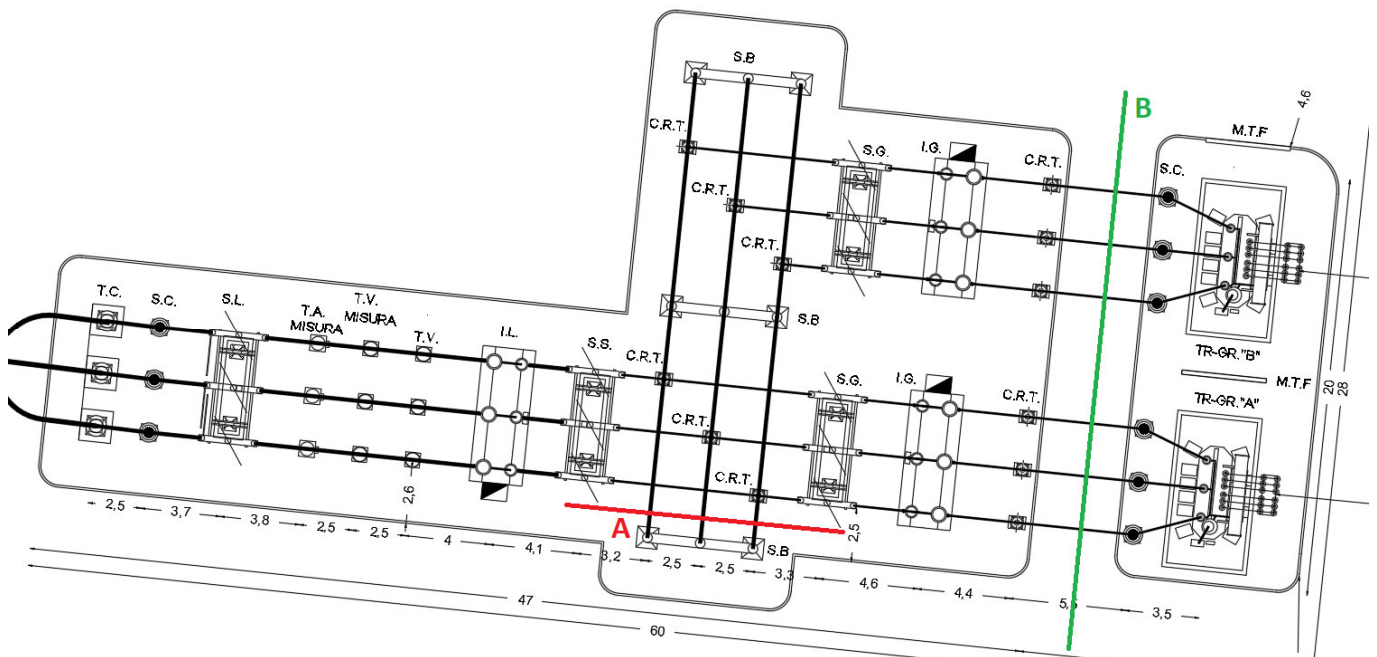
Planimetria del piazzale di SSE con indicazione delle sezioni A e B
